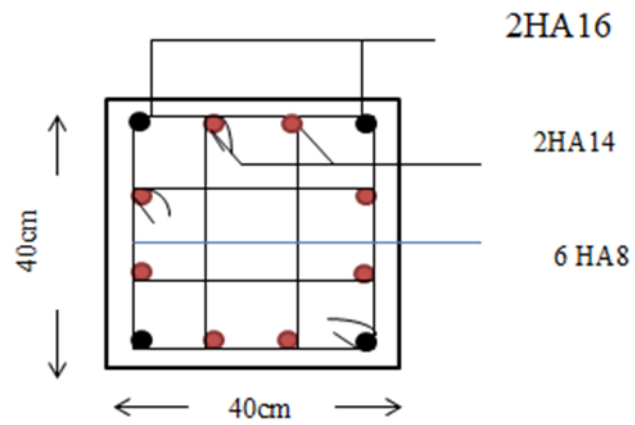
Schéma de ferrailage des poteaux du 3^{ème} et 4^{ème} étages.
